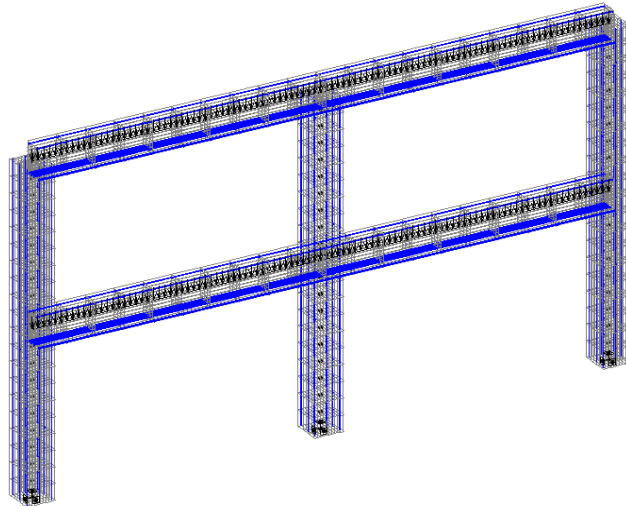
Pórtico com Pormenor das Armaduras (a azul)
